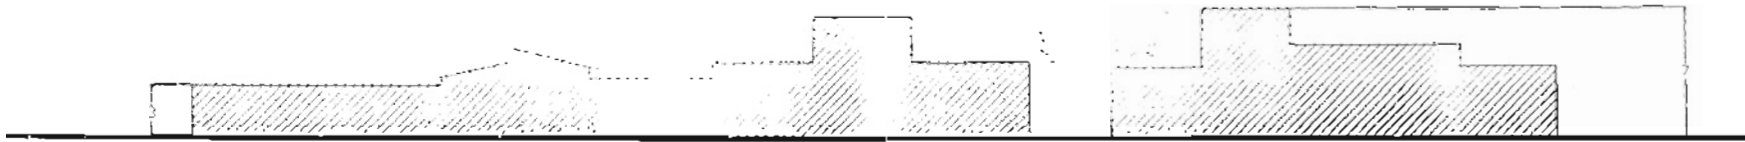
Fachada al oriente del terreno (parte posterior del estadio)
